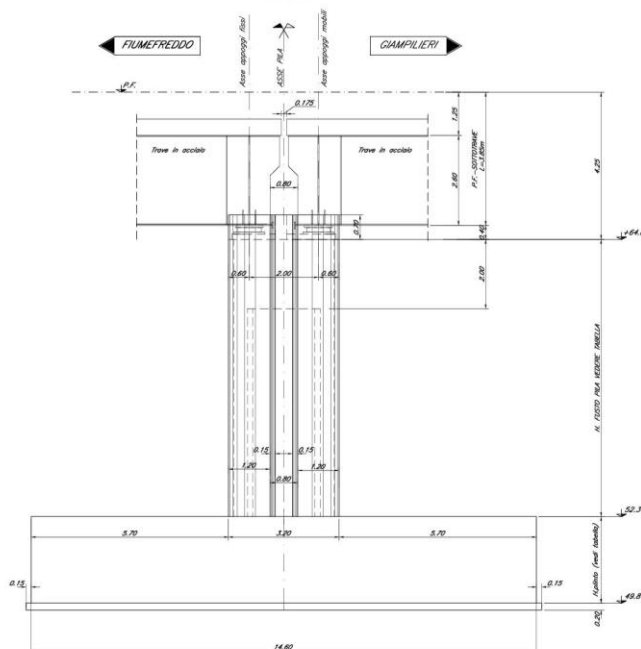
Prospetto Pila P03 - P04 -sezione longitudinale
